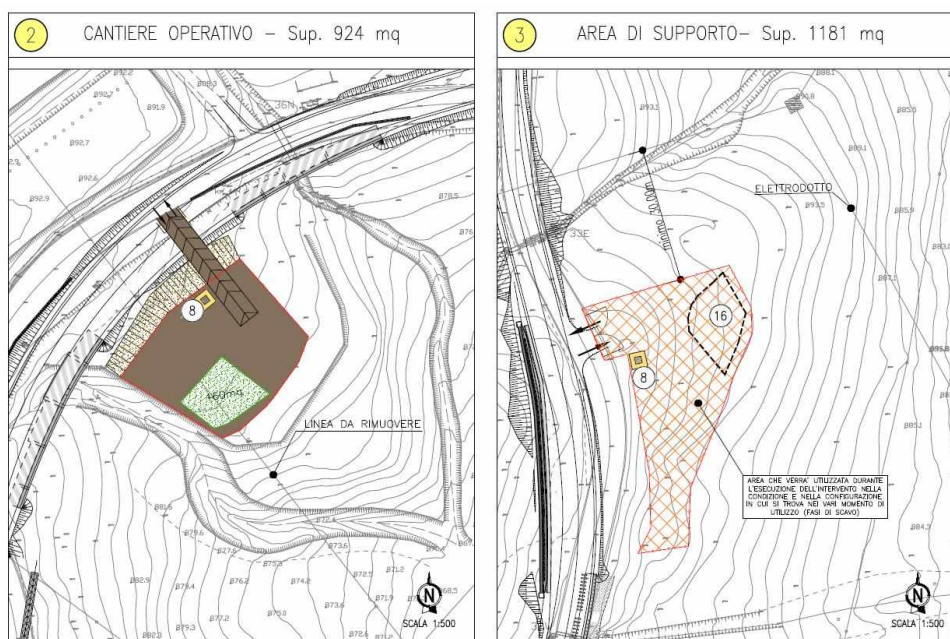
Stralcio planimetrico da CAP0200 su alcuni apprestamenti e disposizioni dei depositi scavi
